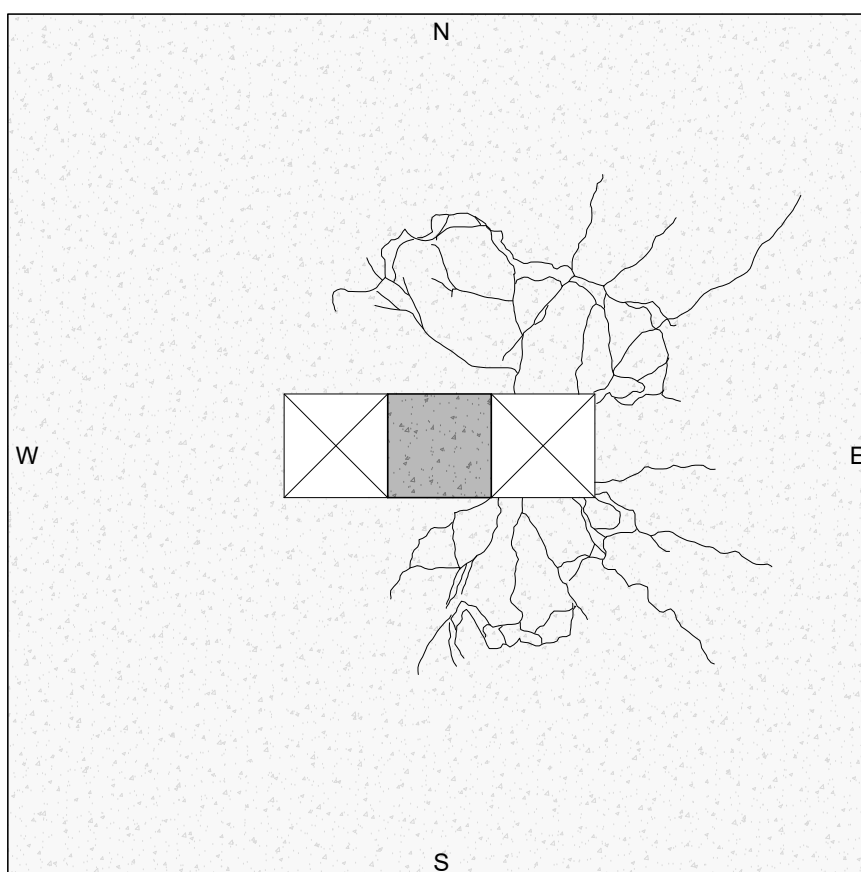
Padrão de fissuração da laje LRFS
